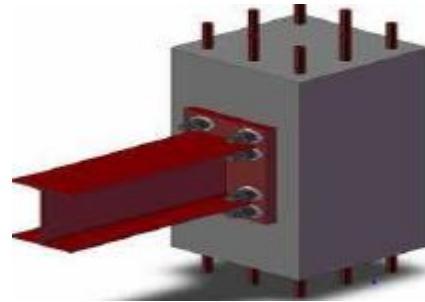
détail d'assemblage poteau béton armé / poutre métallique
